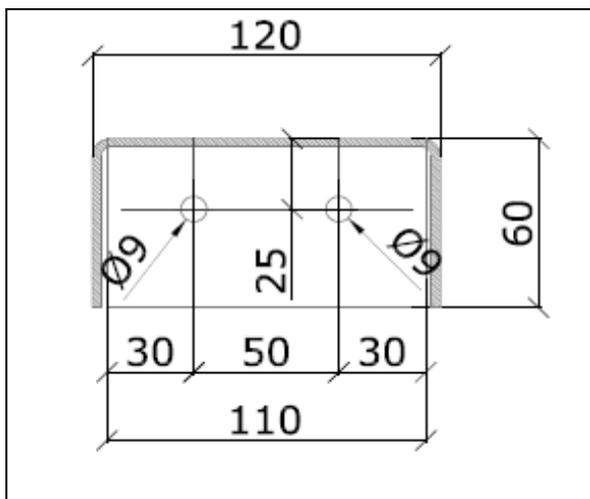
Chevêtre autoconnect F4 – Coupe horizontale
